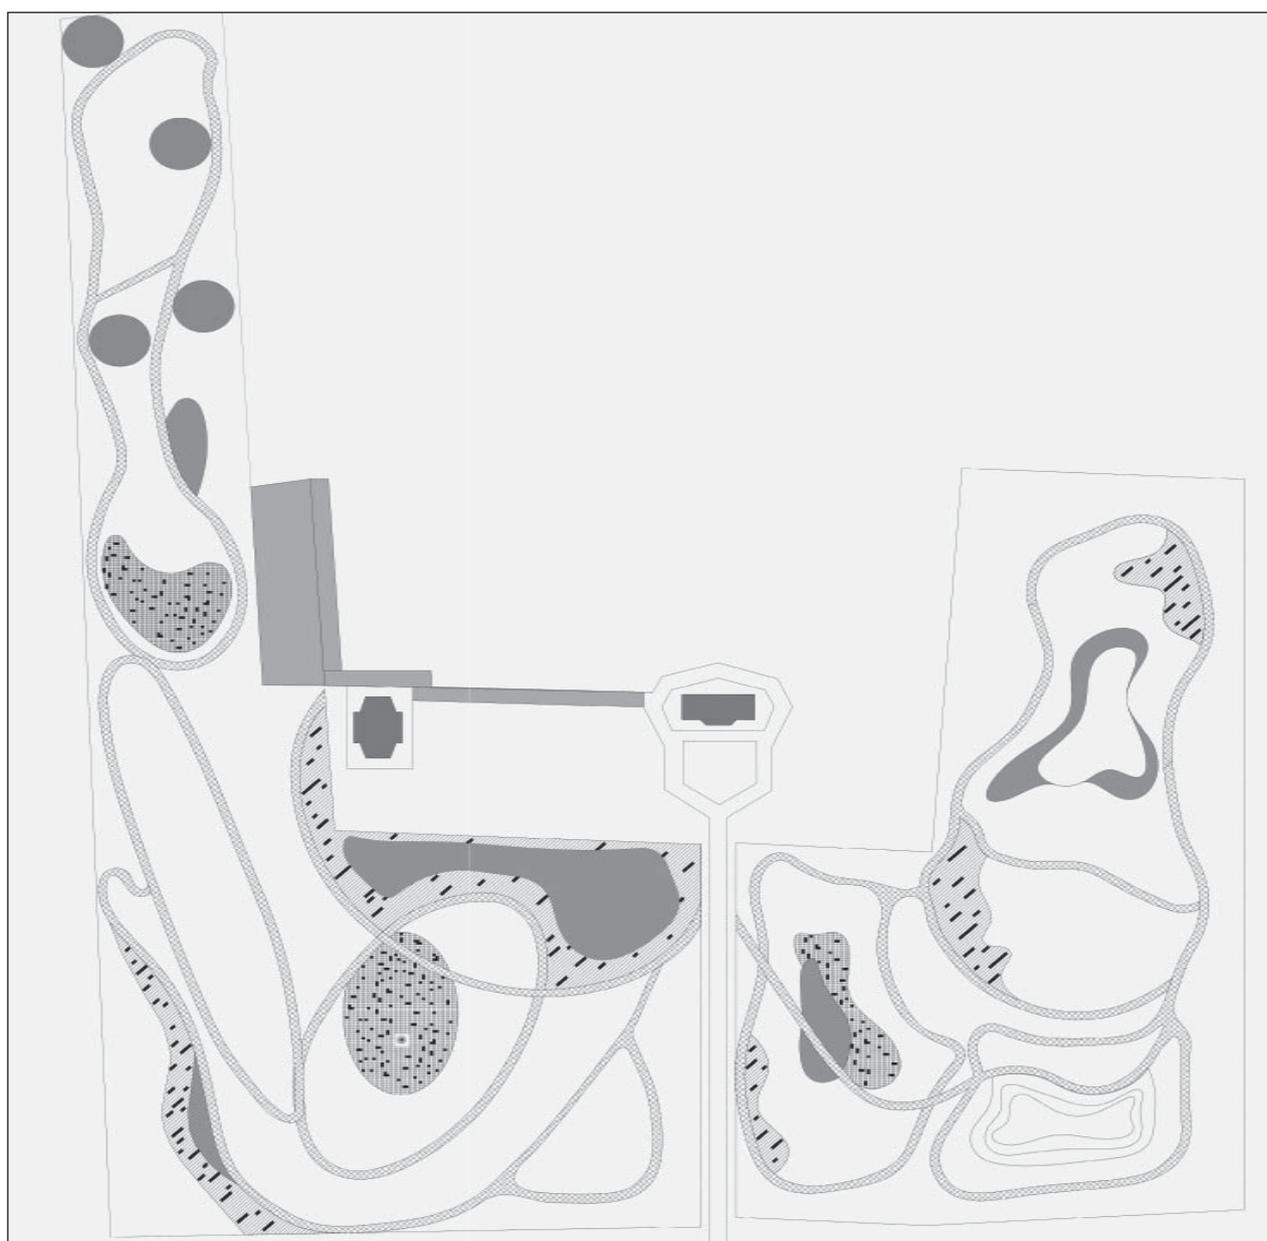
План дорожного покрытия:  — покрытие из сыпучих материалов (набивное покрытие);   — покрытия из декоративного бетона;  — монолитное асфальтовое покрытие
